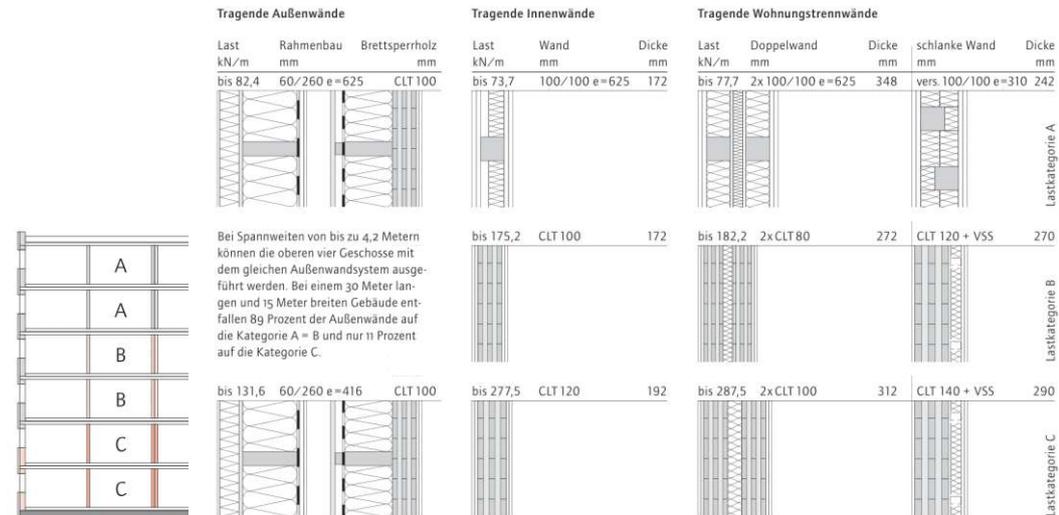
Wanddimensionen für Mehrgeschossigen Wohnbau (Quelle: Mehrgeschossiger Wohnbau Planen und Bauen, proHolz Austria, 2021, Seite 9)
